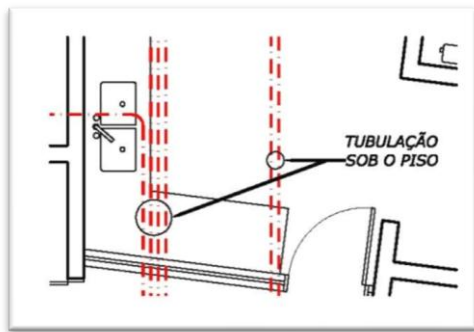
Planta baixa detalhe dutos horizontais.
